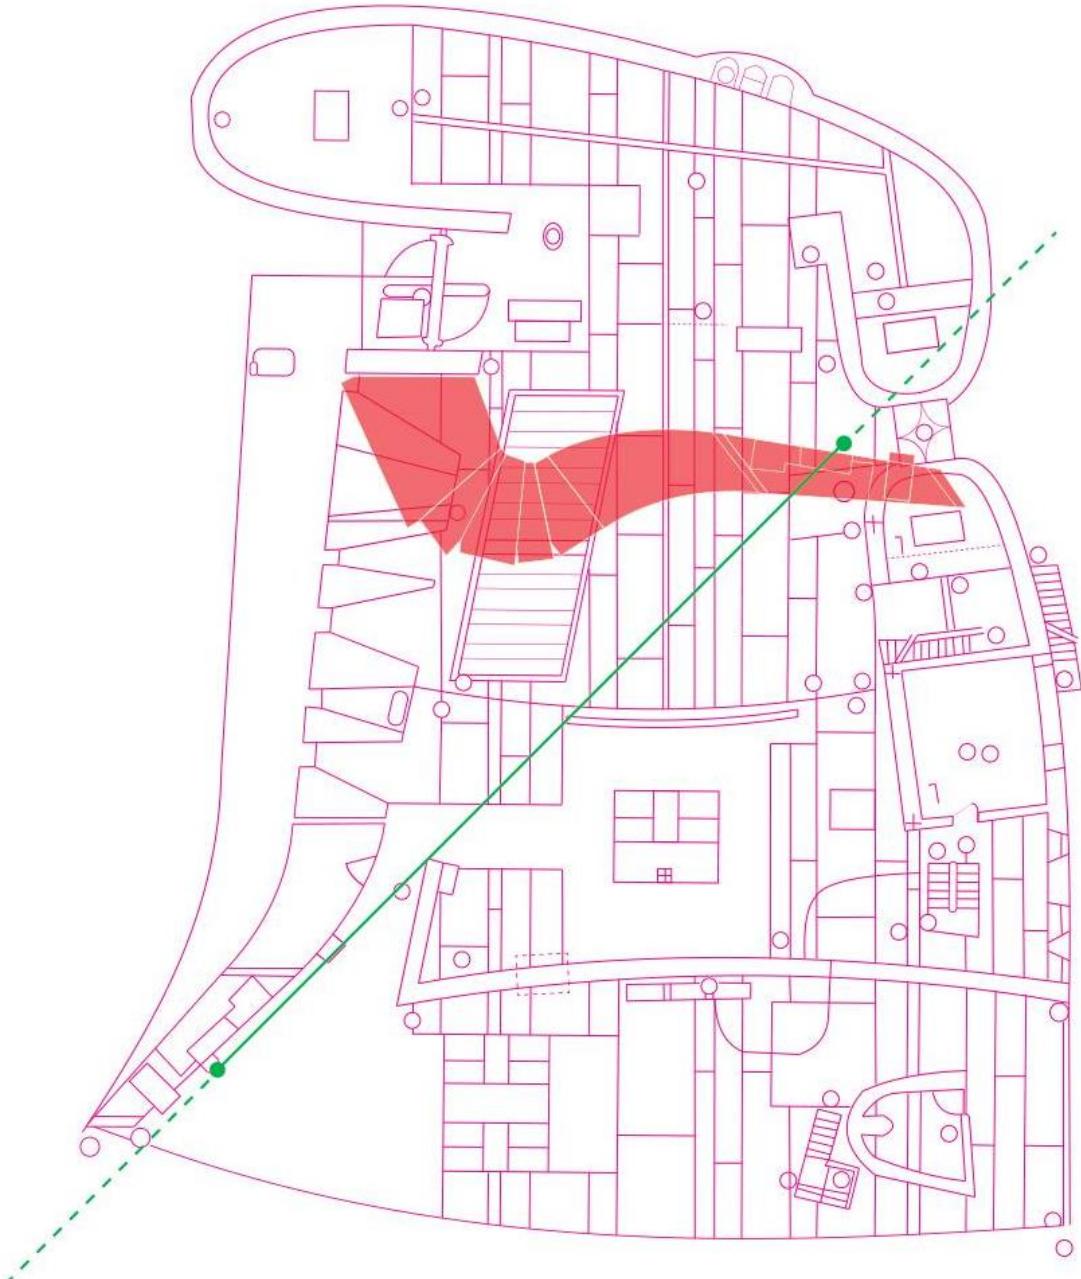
Planimetria con muro sud virtuale e bisettrice dello spazio di Ronchamp.
